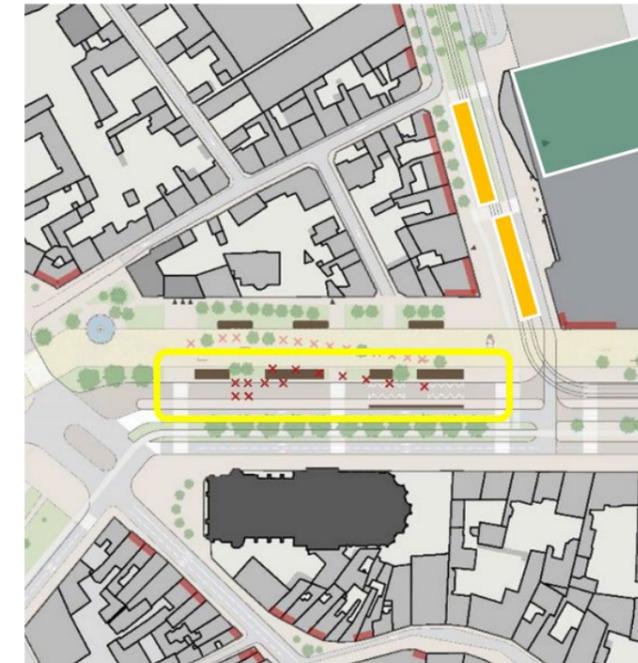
Schéma du « PEM Ouest » à l'échelle de la séquence Place Gambetta – Albert Ier (Source : groupement AMO – étude Plan Guide 2023)
